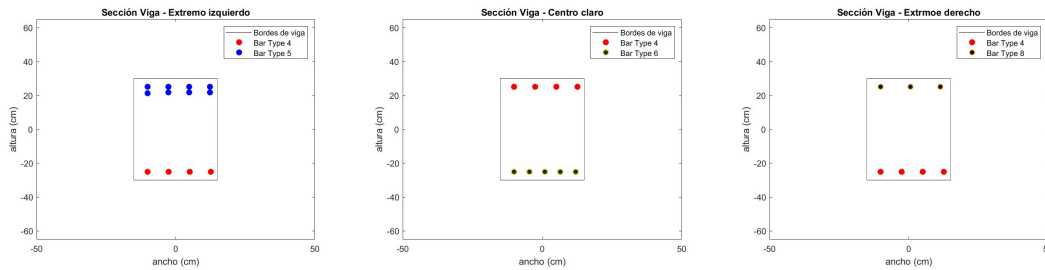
Secciones del modelo estructural 03: (Izq) Sección transversal en el extremo izquierdo de la viga con el refuerzo óptimo, (Cen) sección transversal al centro del claro de la viga con el refuerzo óptimo, (Der) sección transversal al extremo derecho de la viga con refuerzo óptimo..
